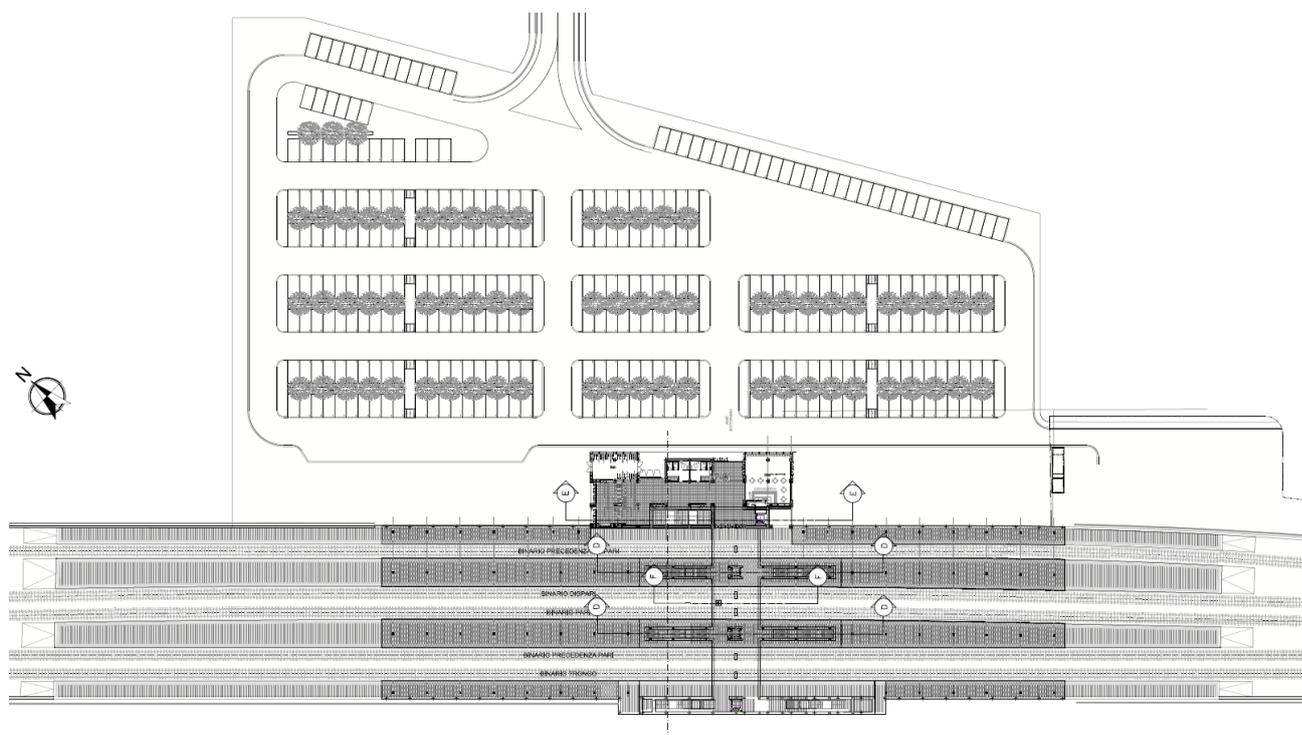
Planimetria d'insieme della stazione e parcheggio di Vigna di Valle
